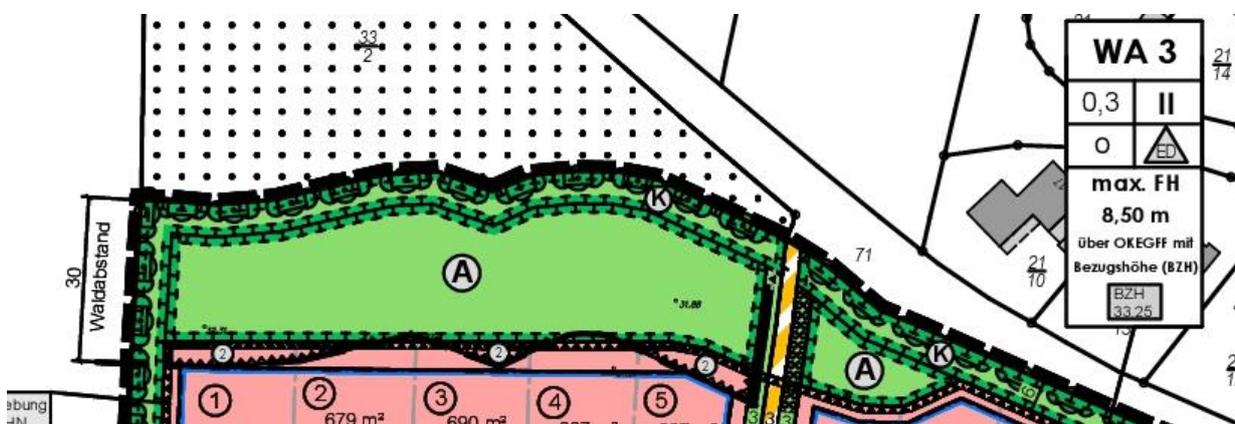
Ausgleichsflächen, Ausschnitt aus der Planzeichnung
